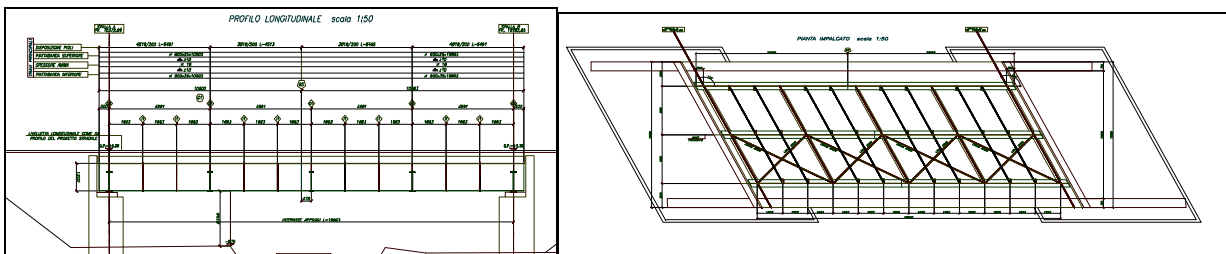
Profilo longitudinale e Planimetria dell'impalcato Ponte Scolo Buoncambietto
